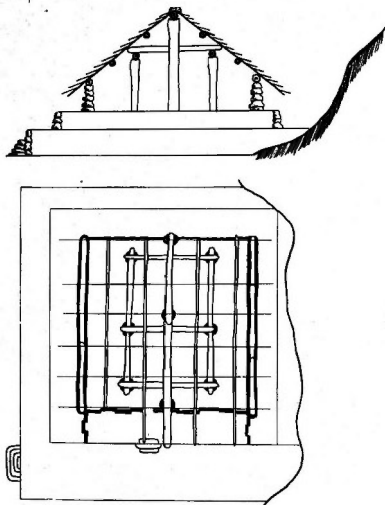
Coupe et plan d'une case à Vanualava, îles Banks.
